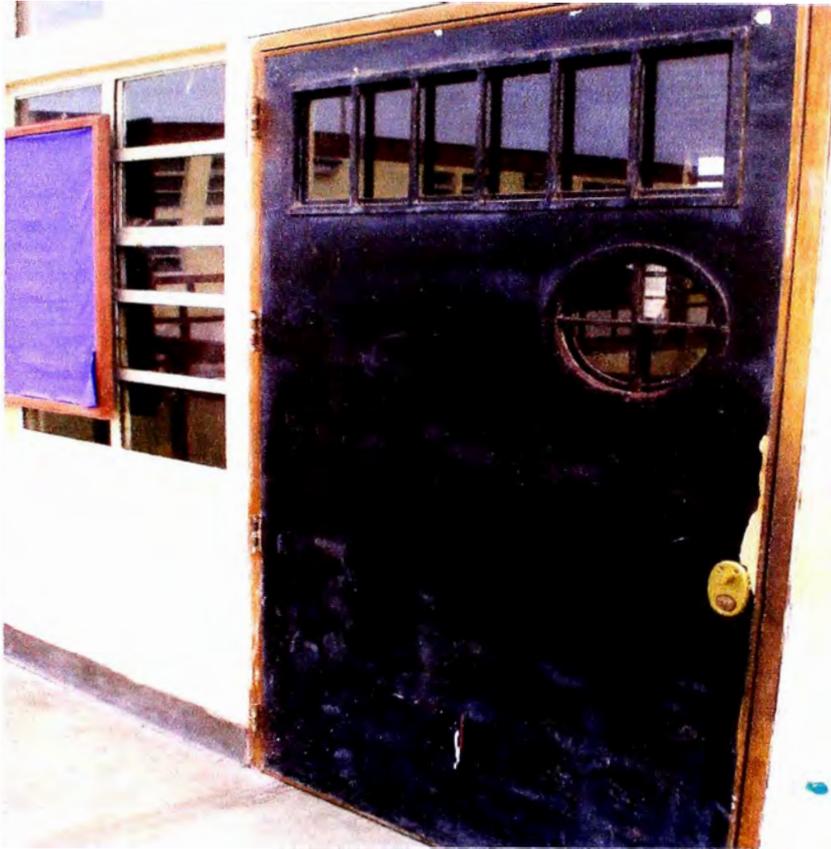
PUERTA DE AULA SEGUNDO NIVEL DE MELAMINE
